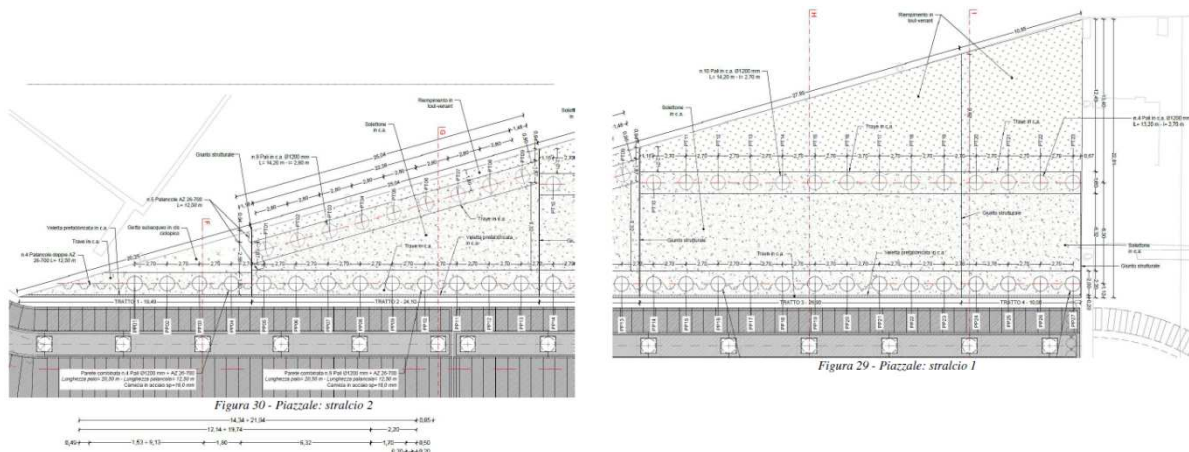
Planimetria piazzale. Stralcio 1 e stralcio 2.
